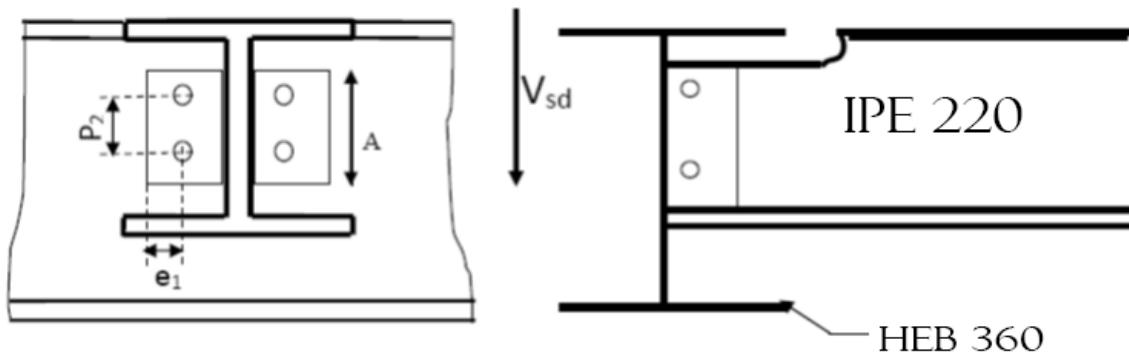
schéma d'assemblage poutre solive (HEB360 - IPE220)
